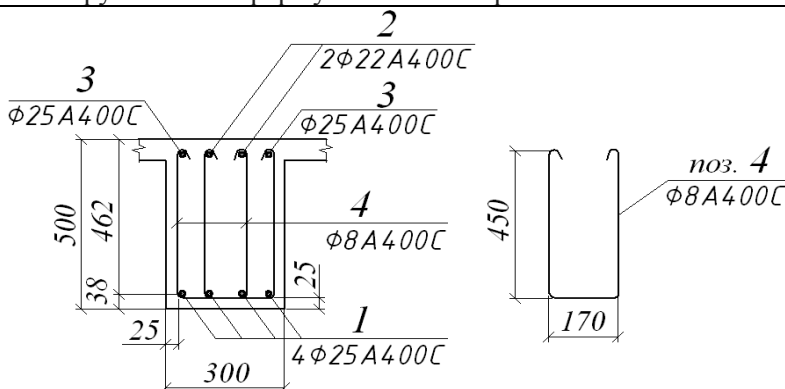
Арматування перерізу балки поперечною вертикальною арматурою: 1, 2, 3 – поздовжня арматура; 4 – поперечна арматура
